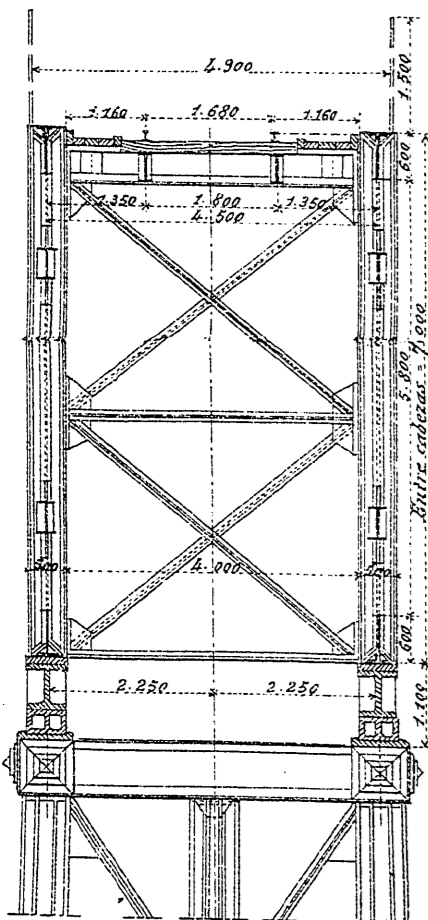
Corte y elevacion longitudinal. (Escala 1/100)
